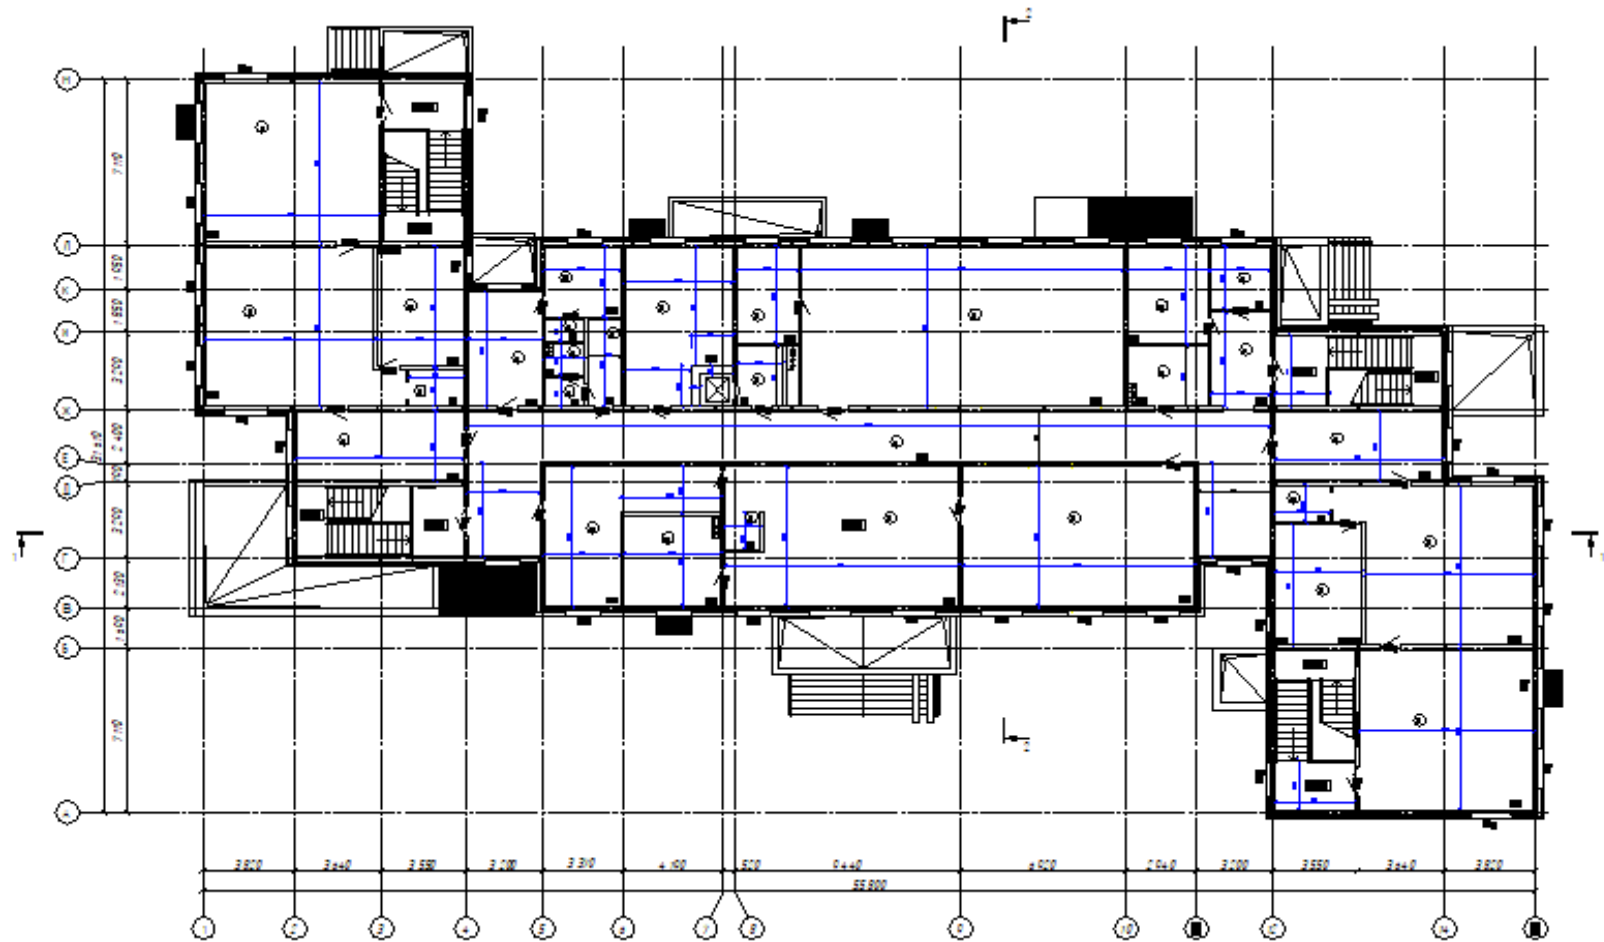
План 3 этажа на отметке + 6,415
